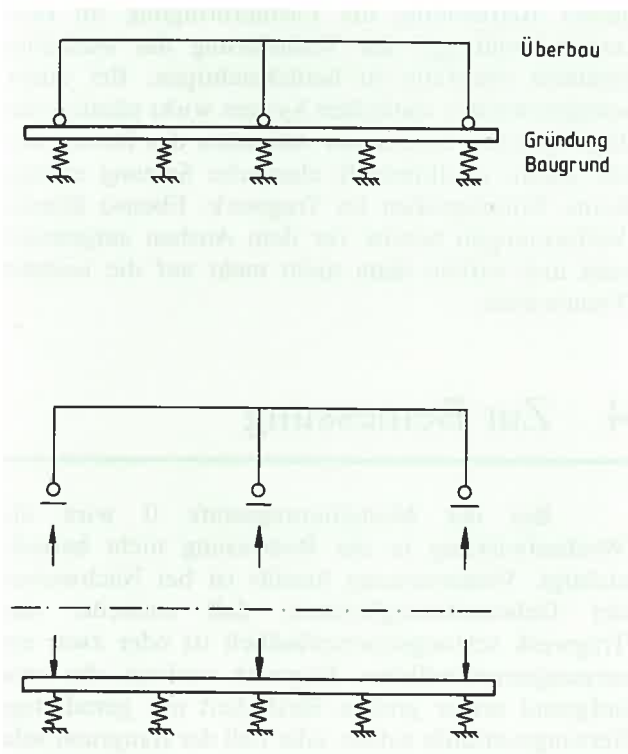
Modellierung Tragwerk-Gründungskörper/ Baugrund bei durchlaufenden Gründungen
